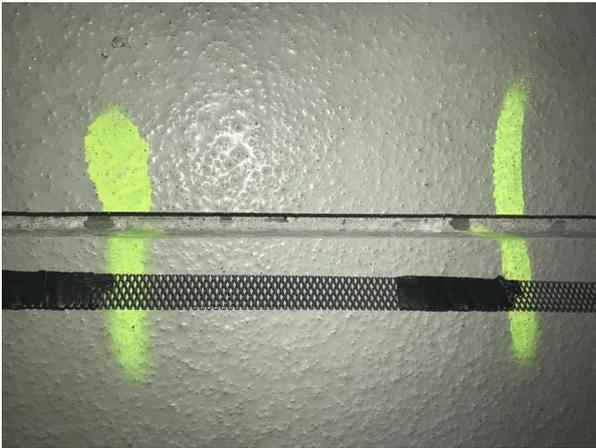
Angeschnittene Bewehrung in Schlitzen
